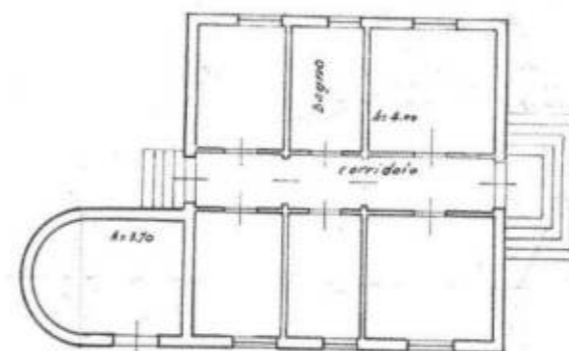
Fabbricato Part. 16. Planimetria Piano Terra
